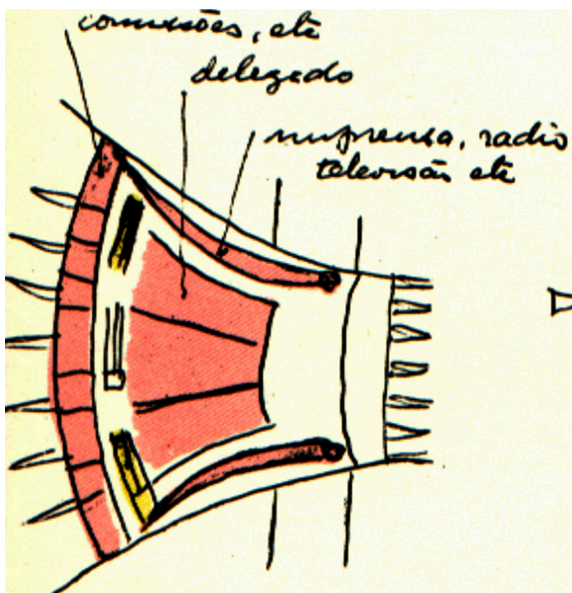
Auditório - Planta Têrreo lanta: Revista Módulo - nº 28 , 1962
